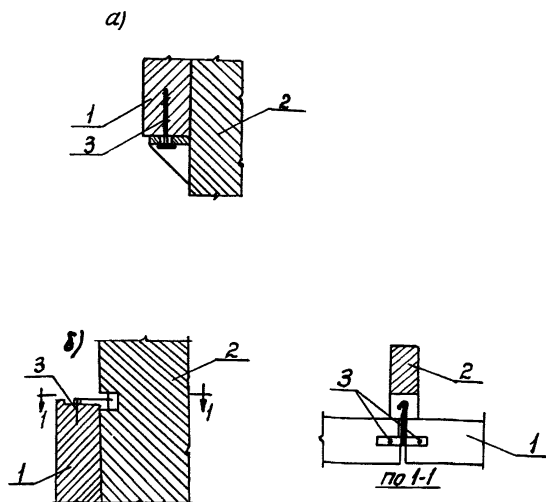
Нагельные узлы крепления / примеры конструктивного решения.
